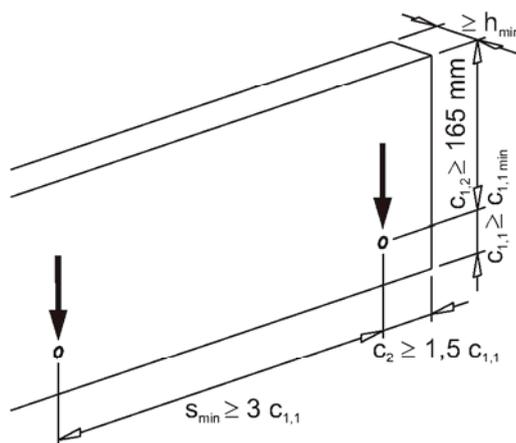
Einbausituation Wandfläche - Querbeanspruchung
